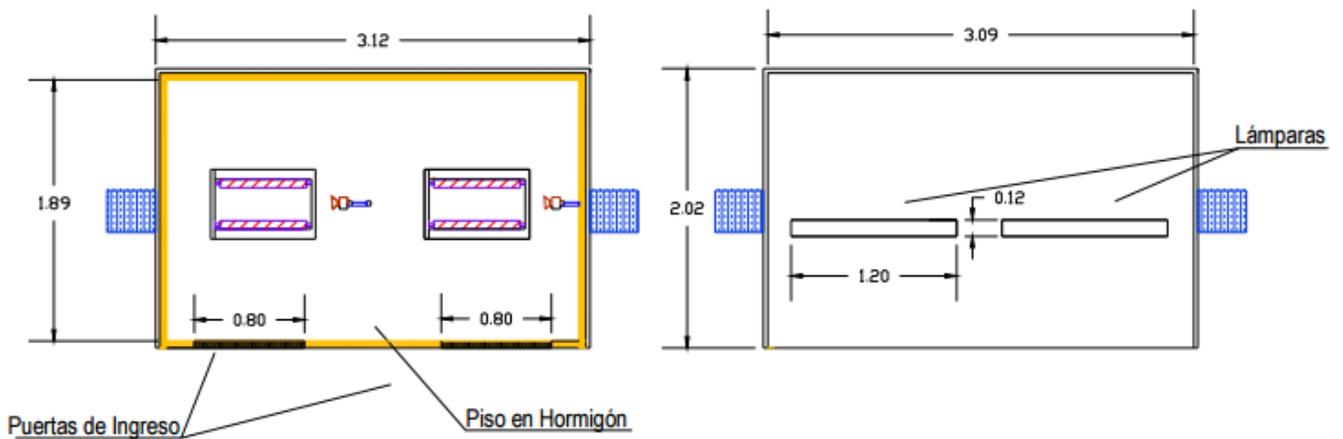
Vista superior interna (izquierda) y externa -techo (derecha)
